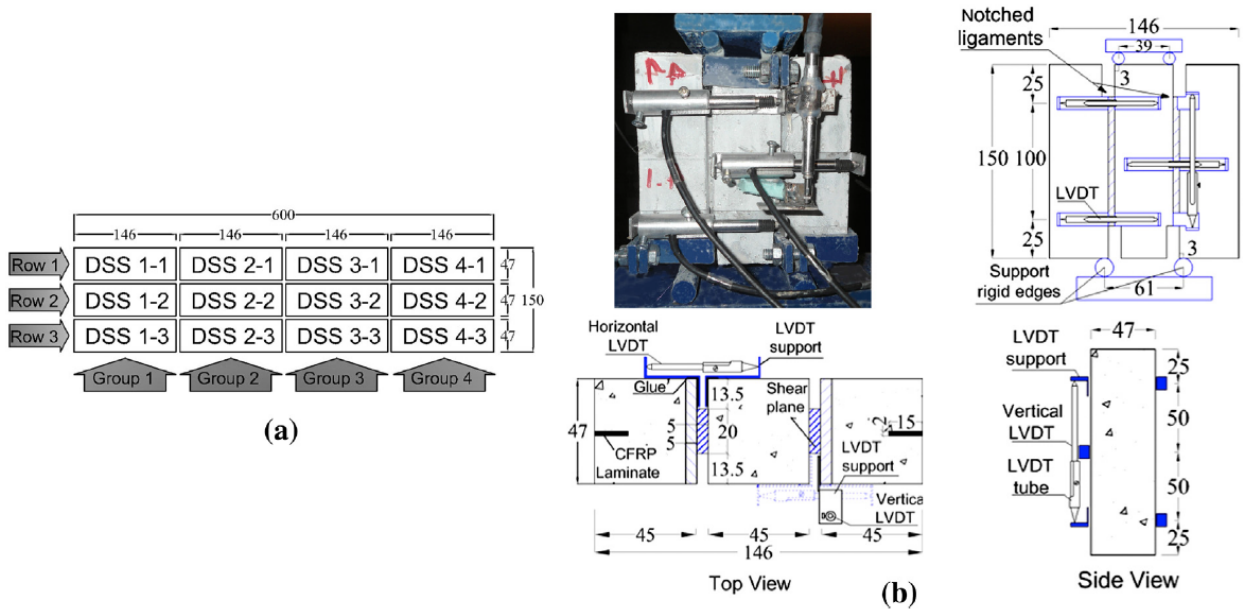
(a) localización de la probeta dentro del elemento prismático, (b) geometría y configuración de carga de las probetas para el ensayo de cortante (dimensiones en mm) [81].
